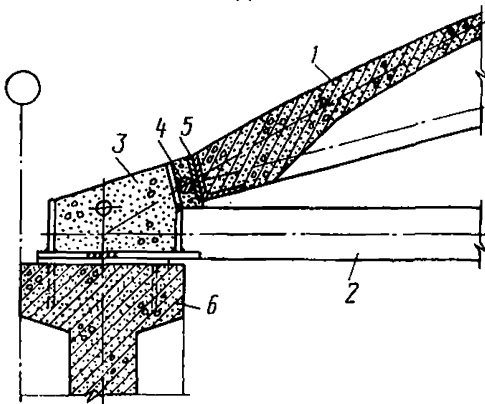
Опорный узел сегментного свода с железобетонными предварительно-напряженными затяжками
